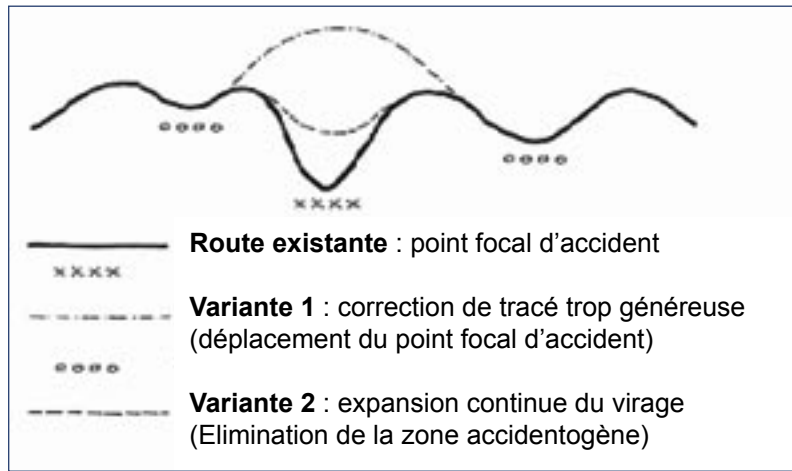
Elimination de points locaux dangereux par expansion continue de virages. [15]
